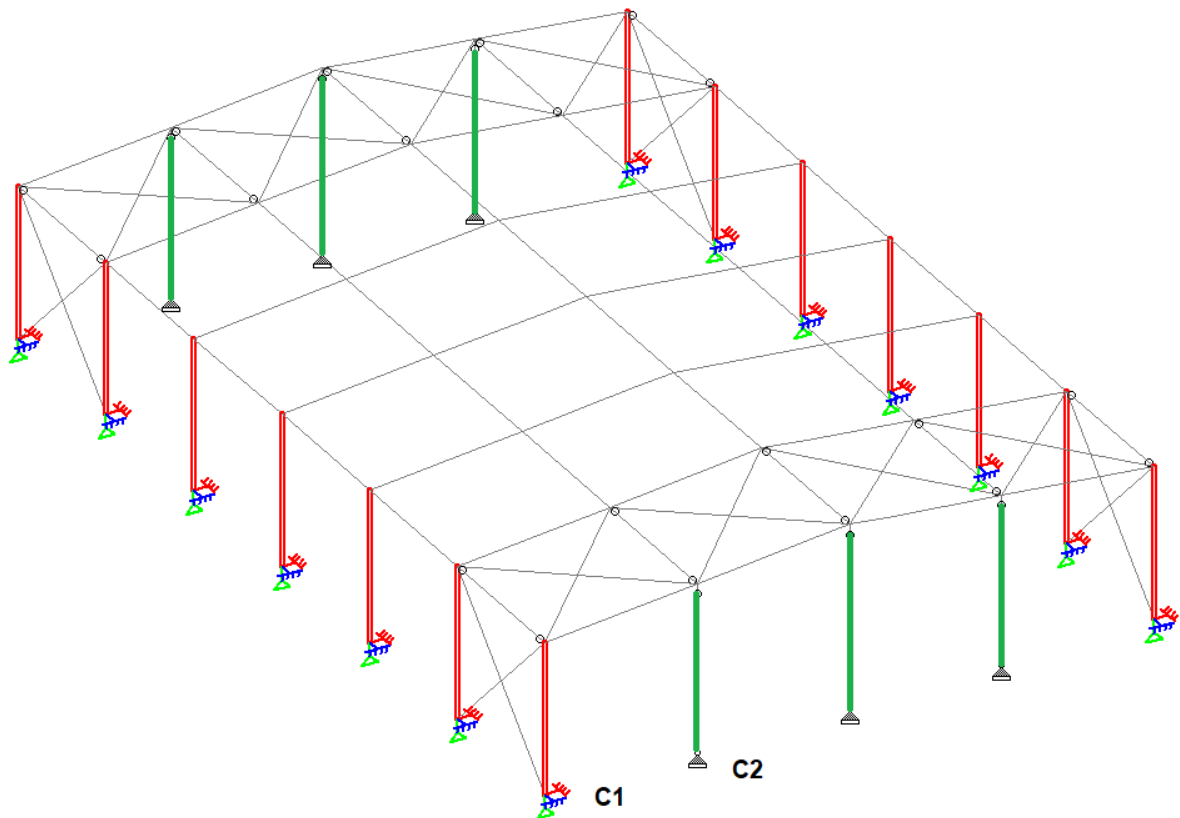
Modelo 3D de estructura resistente - Columnas. Fuente: Elaboración propia.
